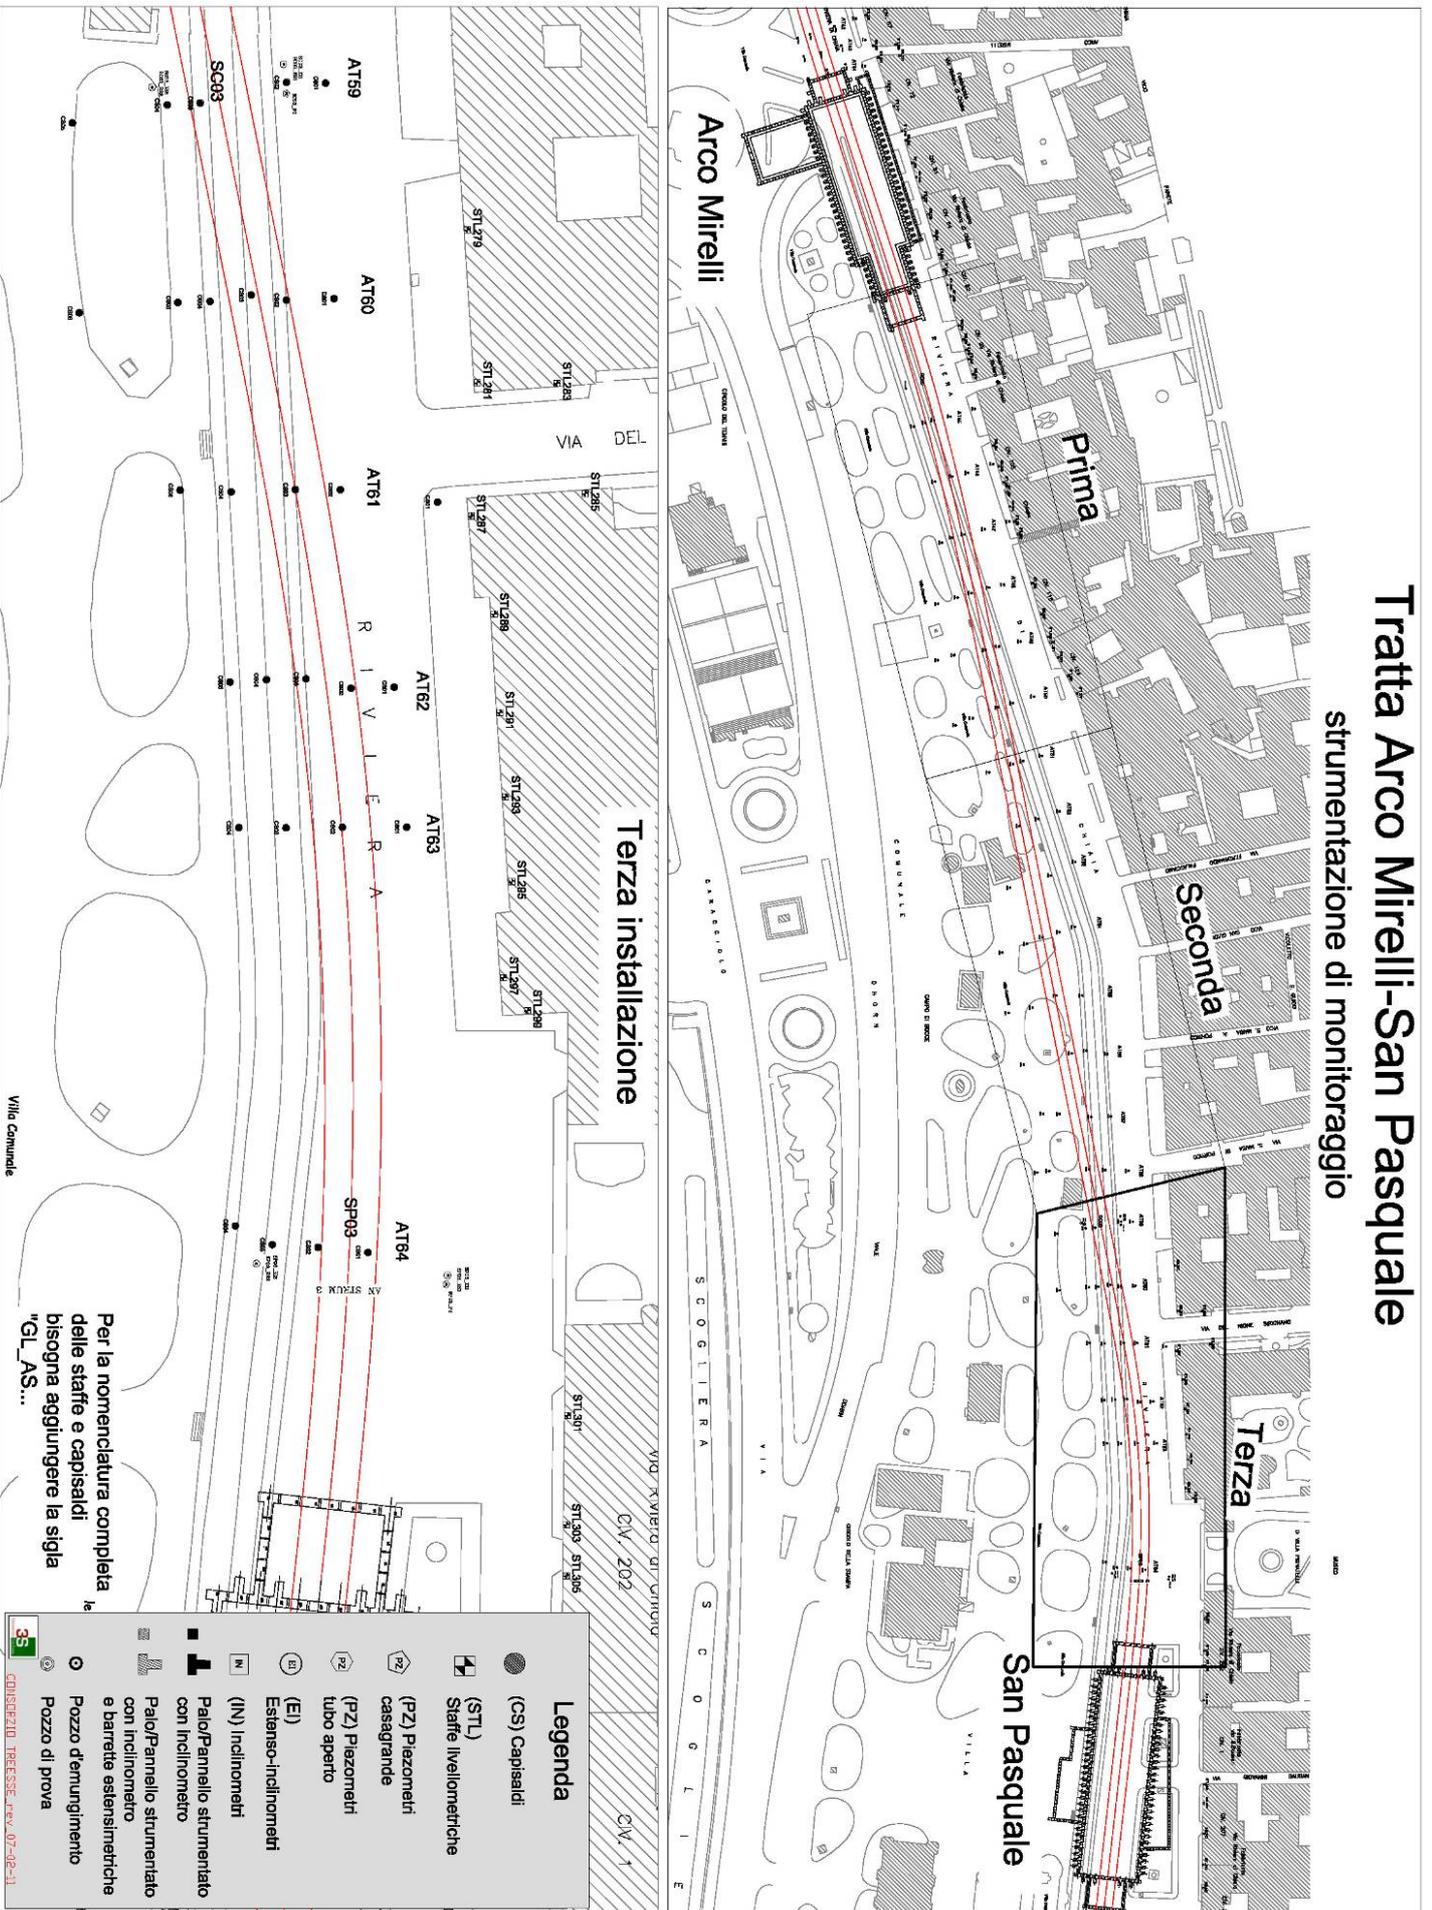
Planimetria tratta Arco Mirelli-SanPasquale, raffigurante la disposizione della terza installazione della strumentazione di monitoraggio
